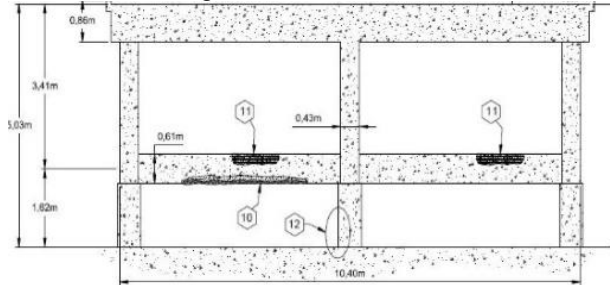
Esquema de daños de la Pila 1 del puente quebrada El Fierro donde se muestra la viga de amarre en estudio. Fuente: SAEP, 2016.
